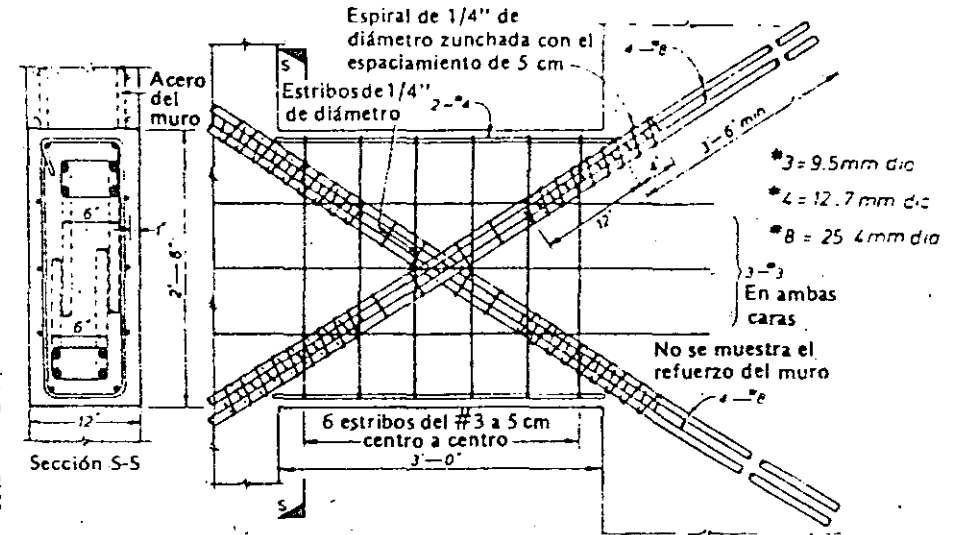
Sugerencia para la disposición del acero en una viga de acoplamiento con refuerzo en diagonal.
